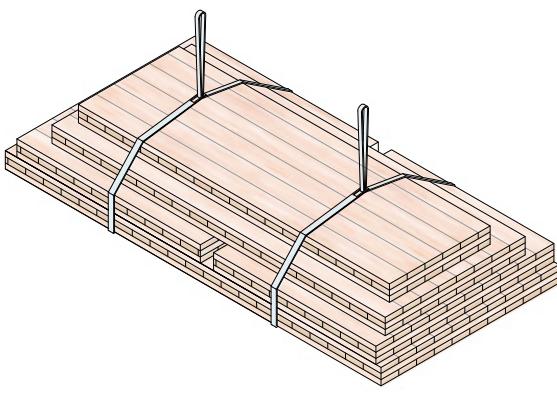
Izaje horizontal de un paquete de paneles CLT con correas de elevación Tipo 3.
